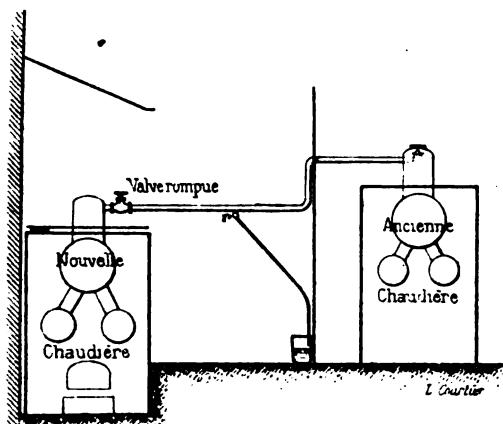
et 16. — Coupe et plan de l'installation, dans une brasserie, à Paris.
